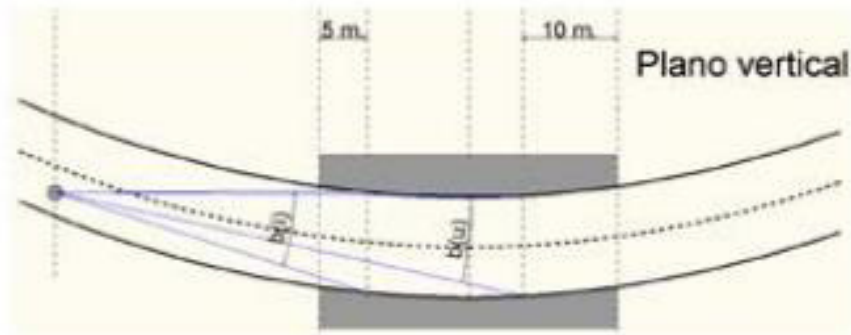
Plano longitudinal y plano vertical. (Continuación).
